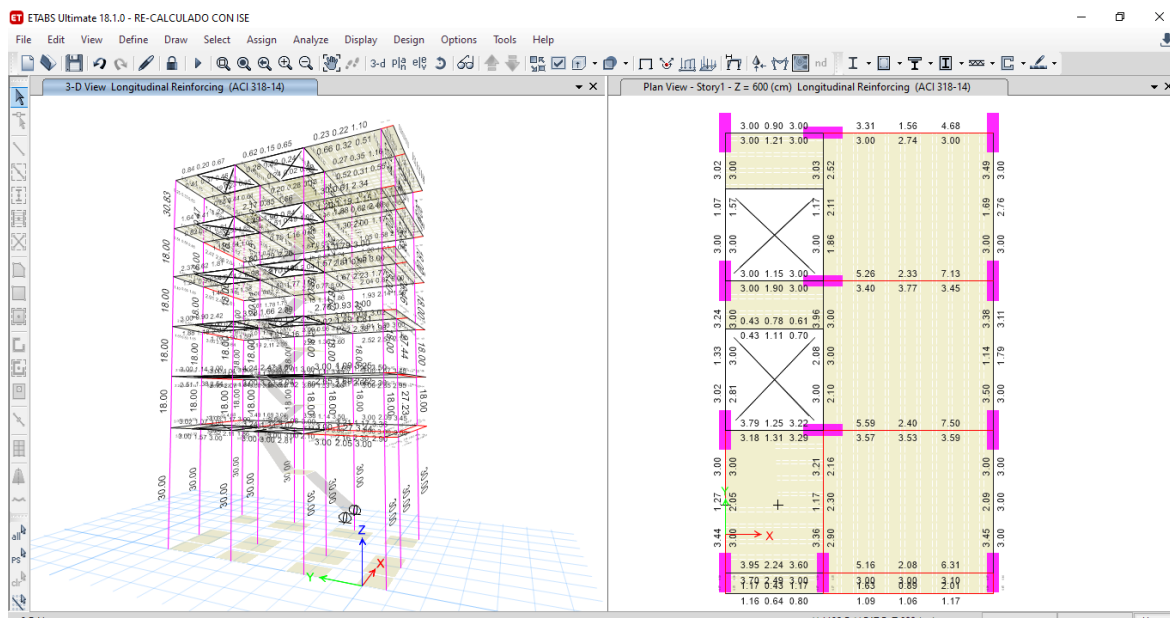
Demanda de acero en Columnas y Vigas – primer nivel.
